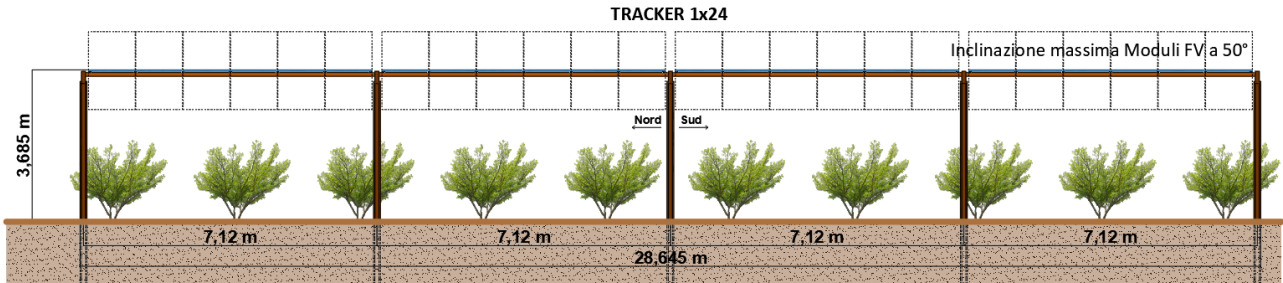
Particolare disposizione moduli su tracker in prospettiva (configurazione 1x24)
